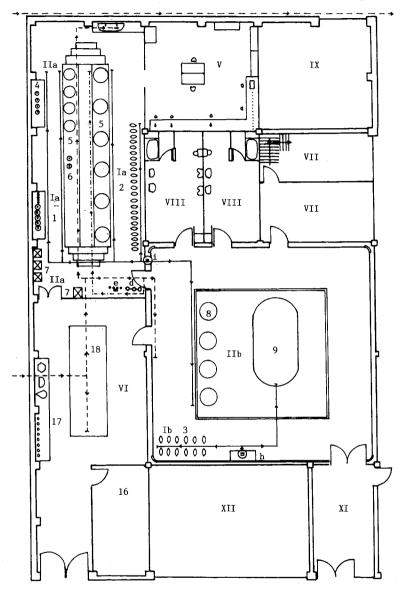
Plano estructural y funcional de las unidades de cultivo planctónico de la planta de maricultura (Escala 1, 134).
